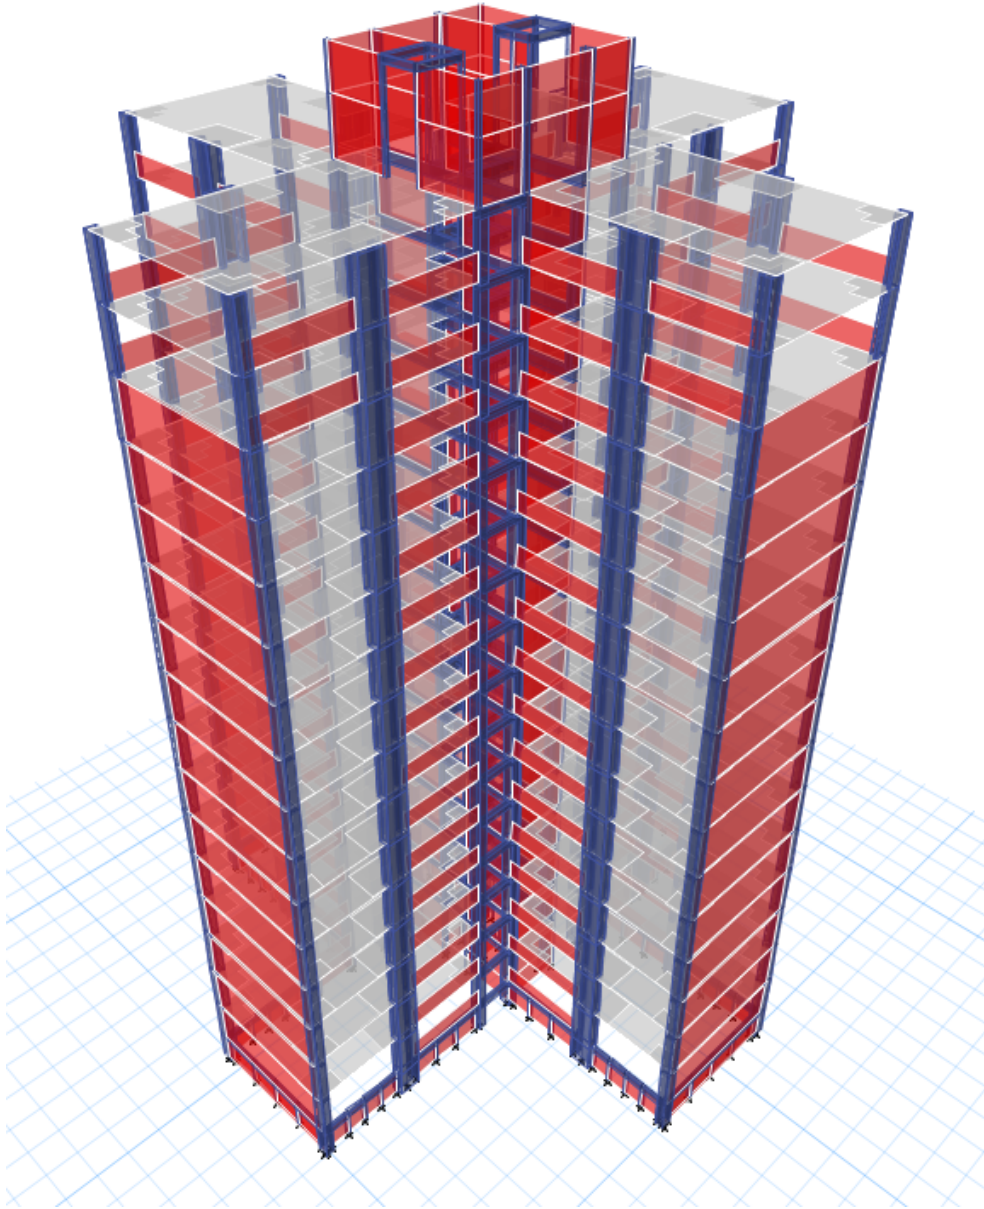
Vista tridimensional del modelo realizado, en azul se muestran columnas, vigas y castillos; en rojo muros y pretilas y en gris el sistema de losa plana con capiteles
